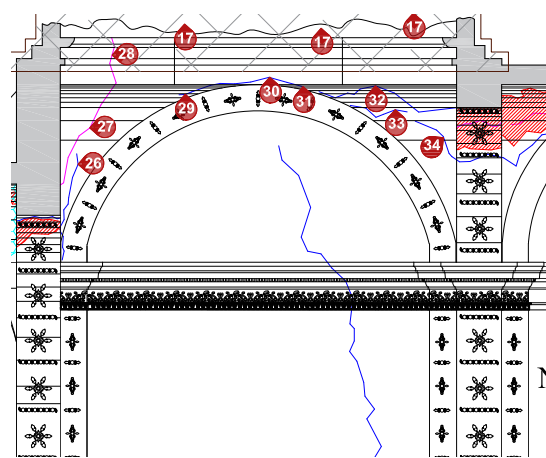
Detalle de afectaciones en juego de molduras de muro interior sur en Nave tramo 2
